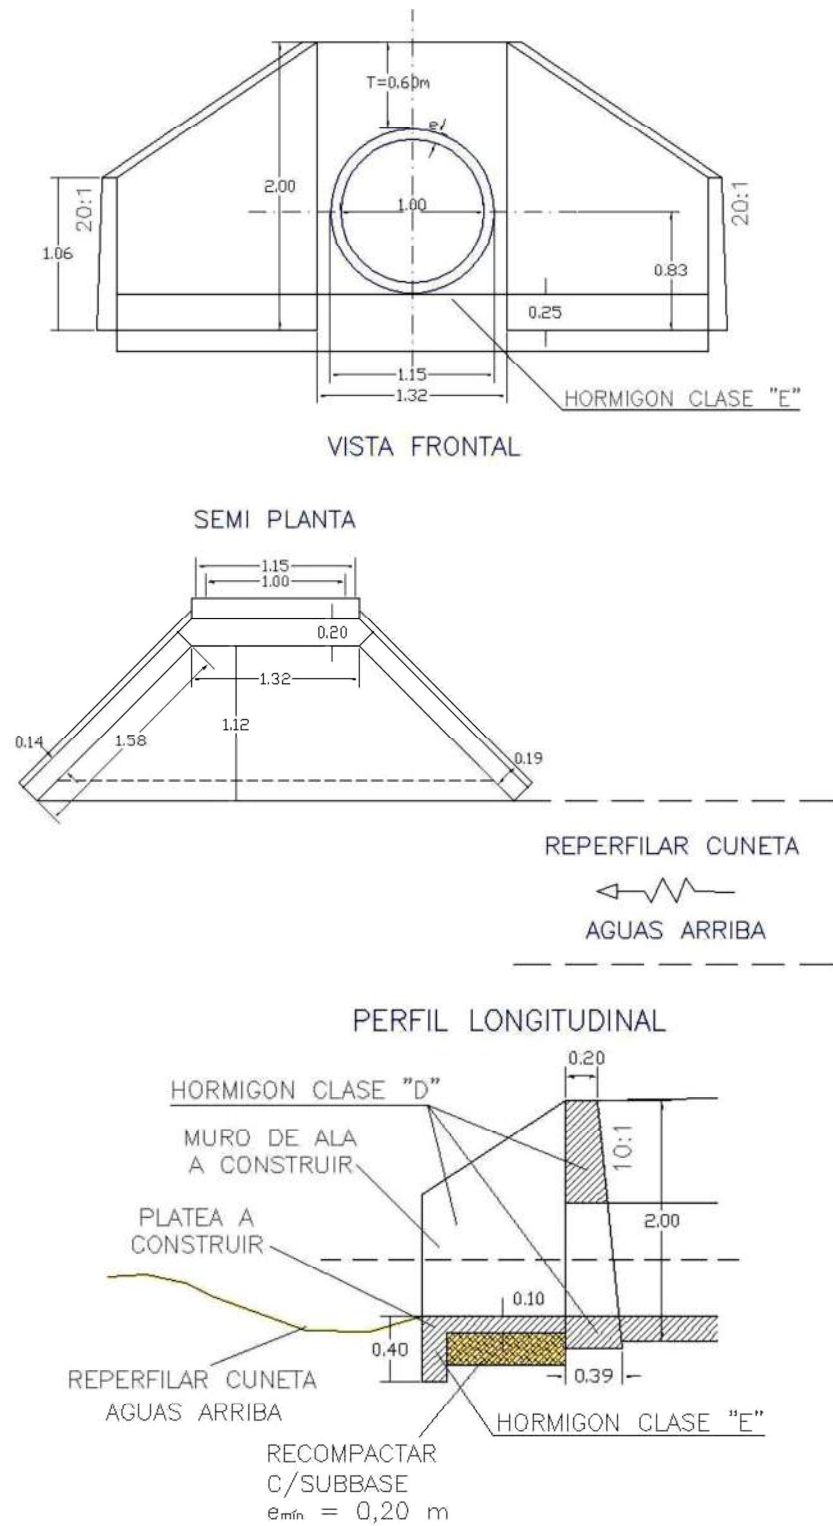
Detalle de cabezal de ingreso a alcantarilla, a construir.
